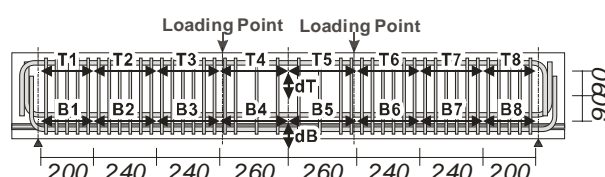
変位計設置位置 (PRC)(Unit: mm)
